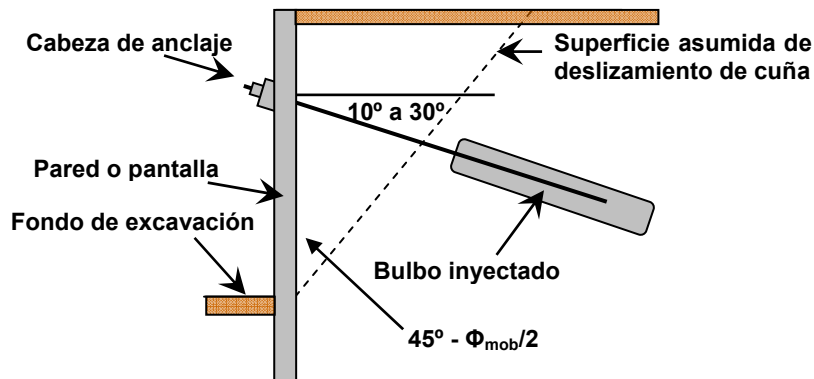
Ángulo de inclinación idónea en el muro anclado
